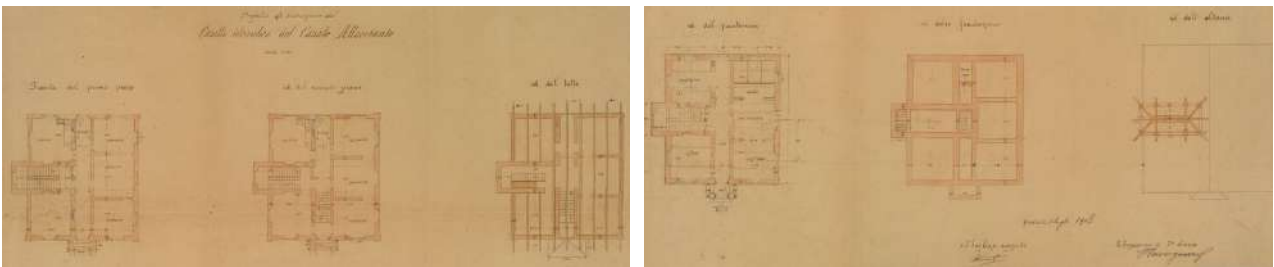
Progetto di costruzione del Casello idraulico del Canale Allacciante, anno 1904. Nella tavola sono raffigurate le piante delle fondazioni, del piano terreno, del primo piano, del secondo piano, del tetto e dell’altana del casello idraulico del canale Allacciante (CASTORE Regione Toscana)
